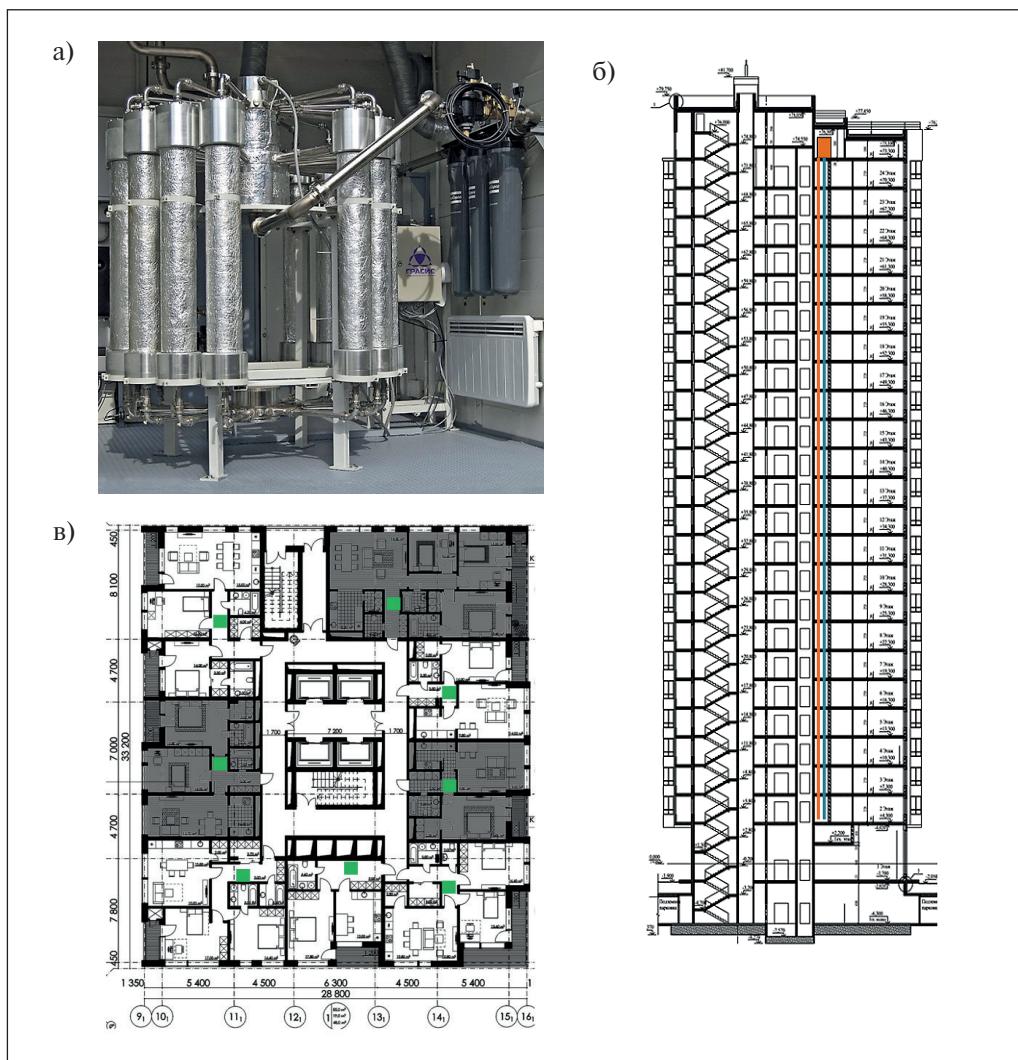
МСВ на техническом этаже (а), разрез высотки с азотным и воздушным трубопроводами (б), планировка этажа с ЭГВСИП (в)
